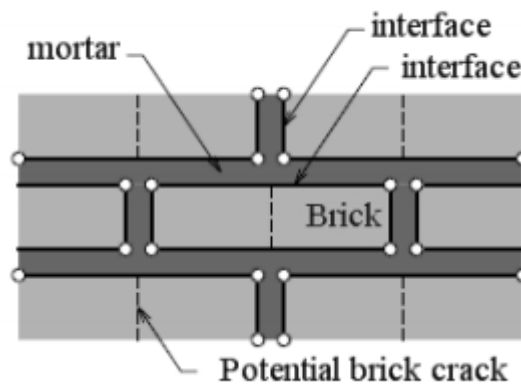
Modelo de muro de mampostería discreto simplificado [41]
